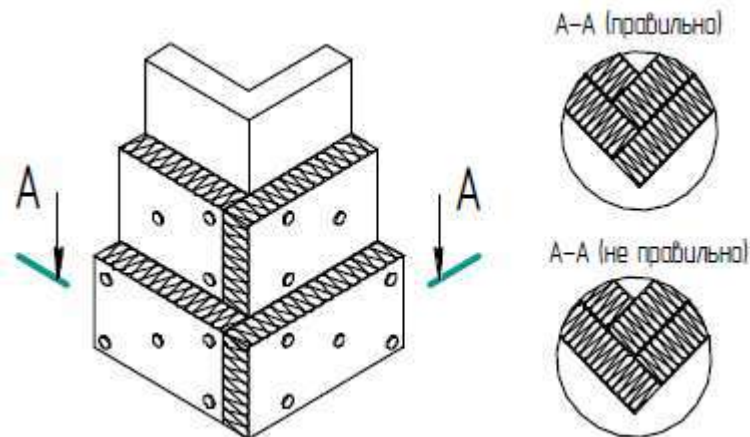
Схеми укладання плит утеплювача на кут будівлі. Двошарове утеплення.
